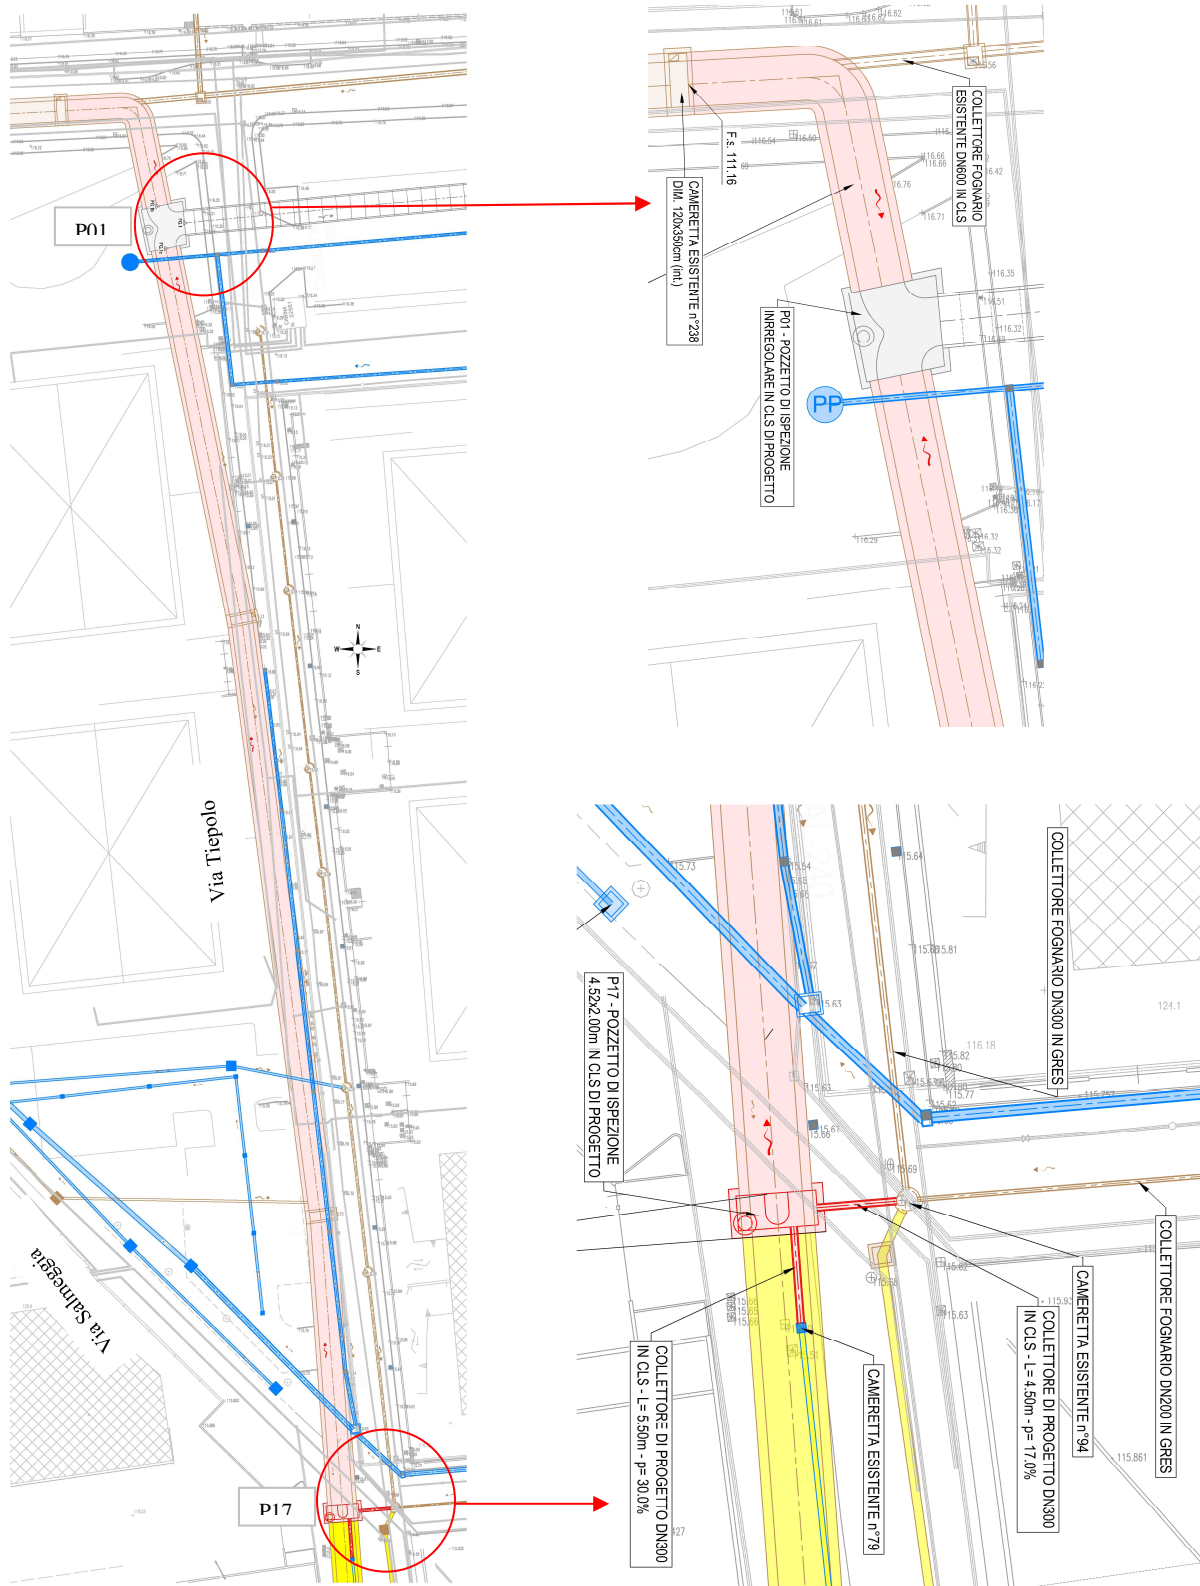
Interferenza FGN 22 - Planimetria di progetto e particolare pozzetto di testa P17
